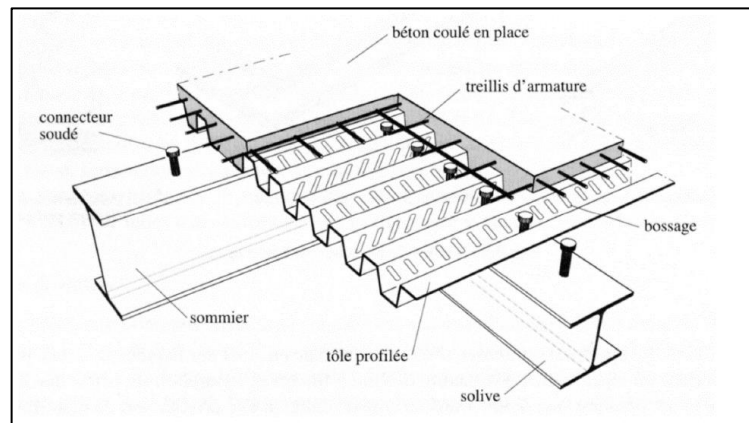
Schéma représentatif du plancher collaborant [12]
